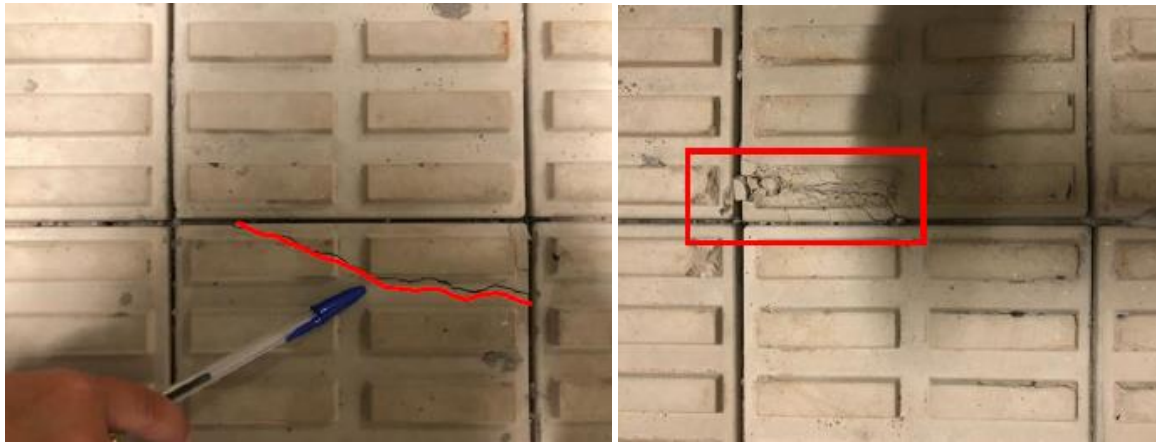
Fissuras nas juntas de dilatação do subsolo
